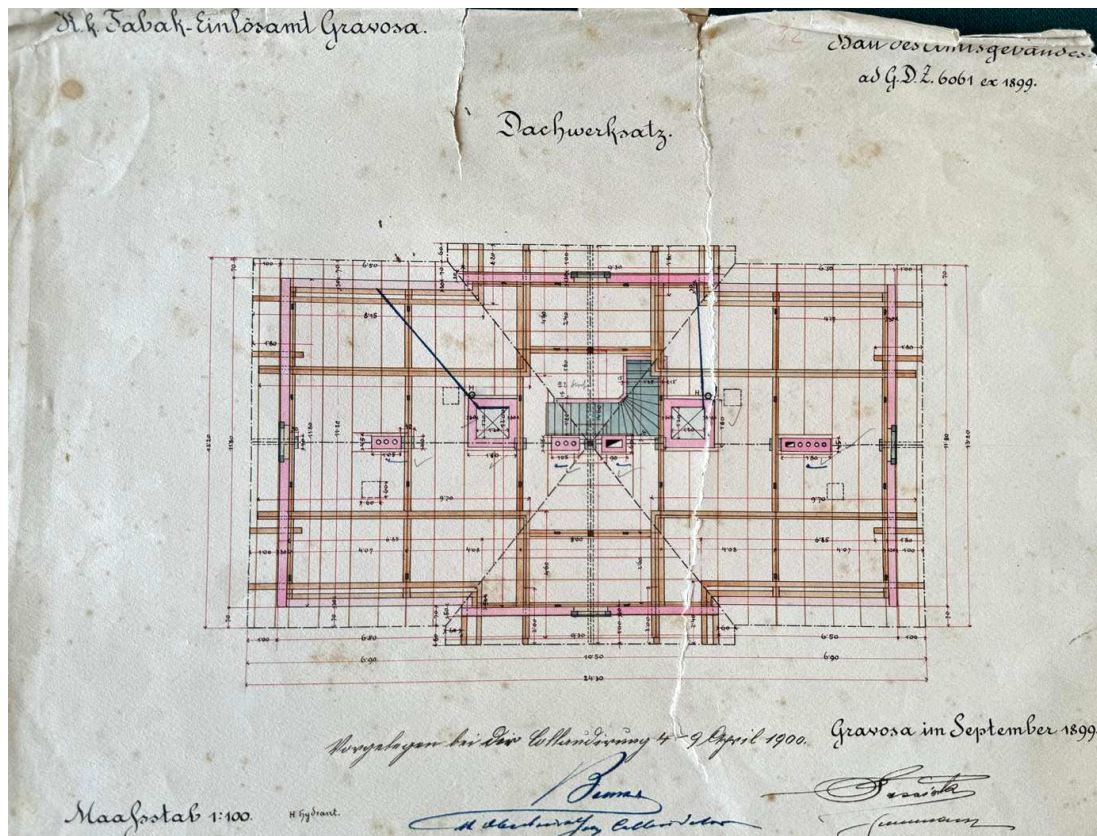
Verwaltungsgebäude in Dubrovnik, Dachgrundriss, 1899.
